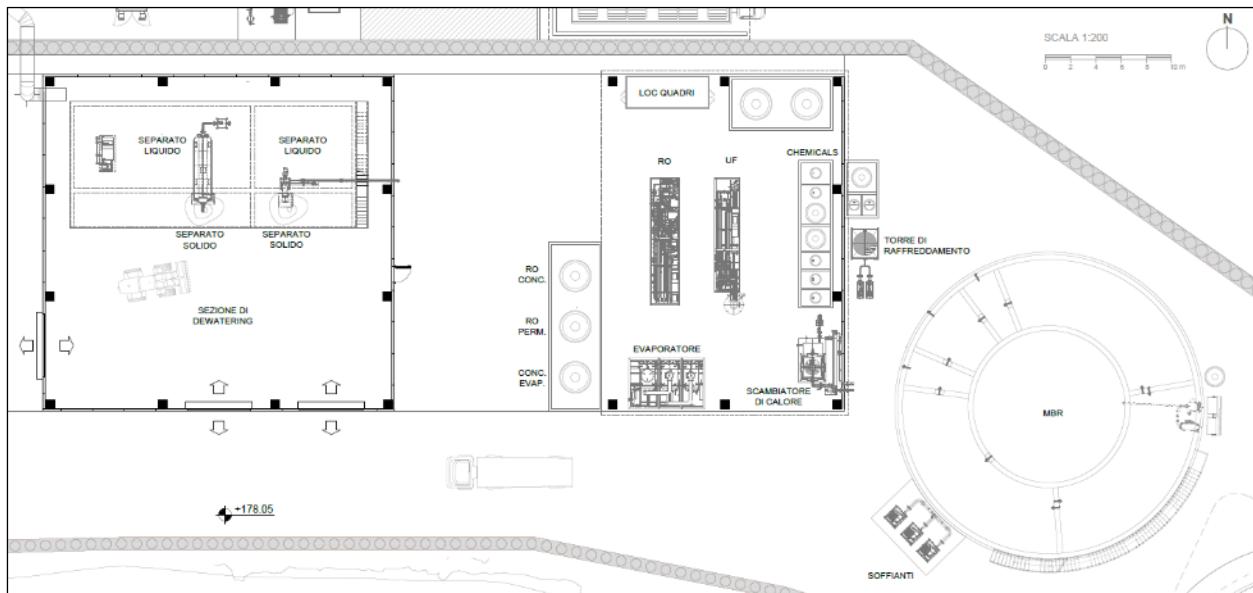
Layout impiantistico della sezione di depurazione del digestato
